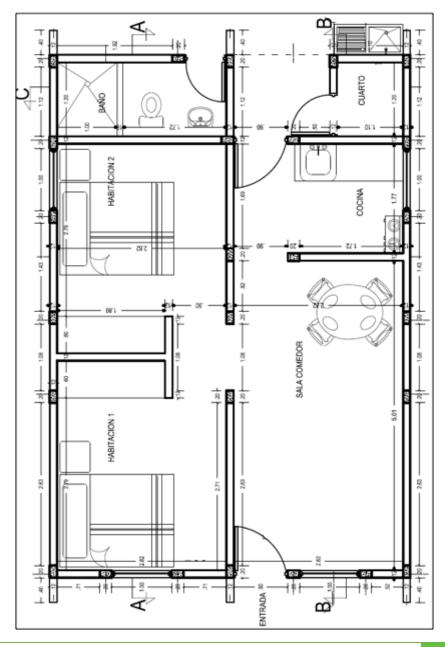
Plano arquitectónico en planta - vivienda tipo madera
